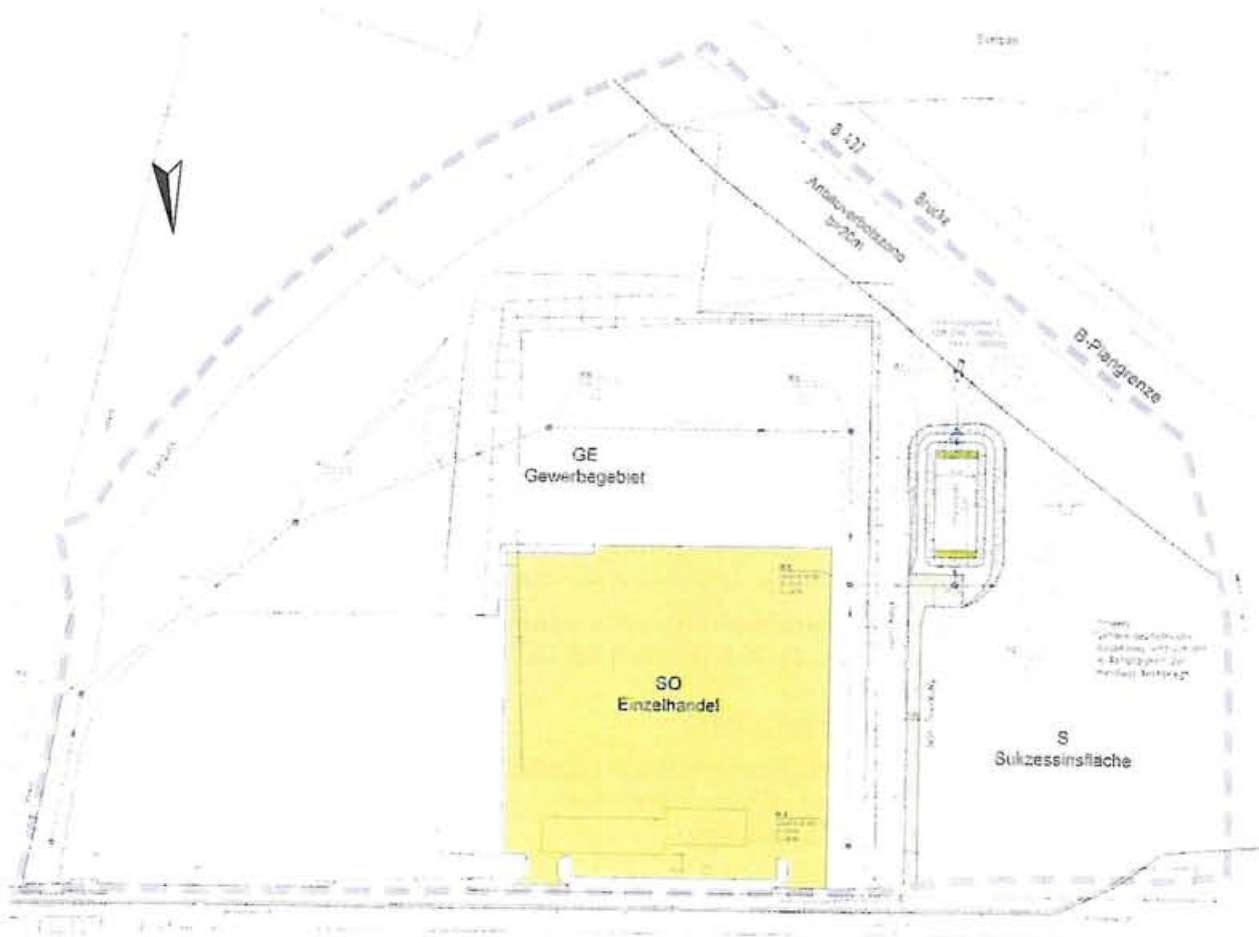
Lageplan zum Entwässerungskonzept des Gewerbegebietes (GE)
